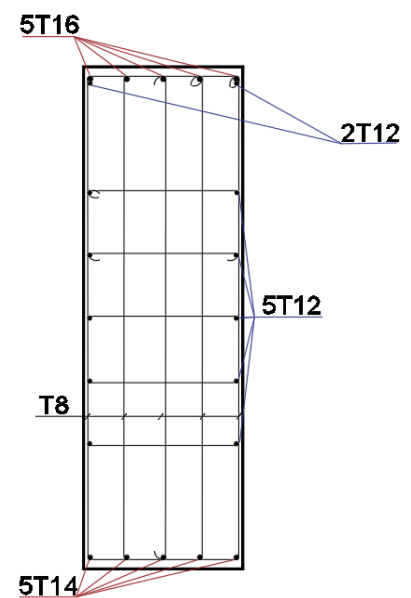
Schéma de ferrailage des nervures sur travées.
